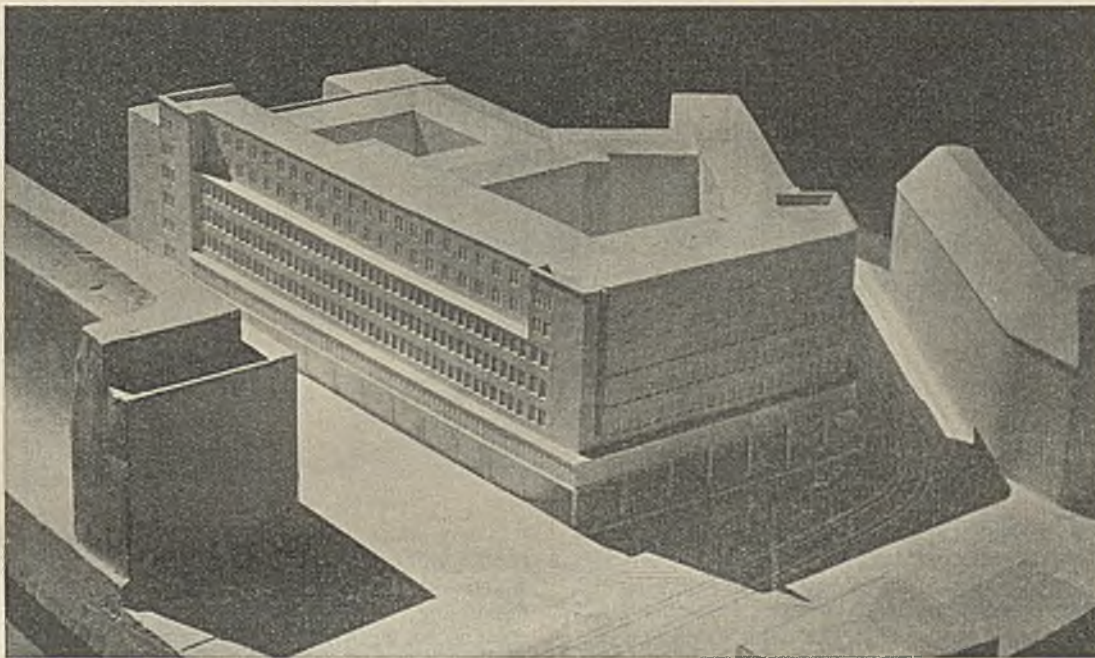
Modellaufnahme des Zeppelinbaues in Stuttgart.
